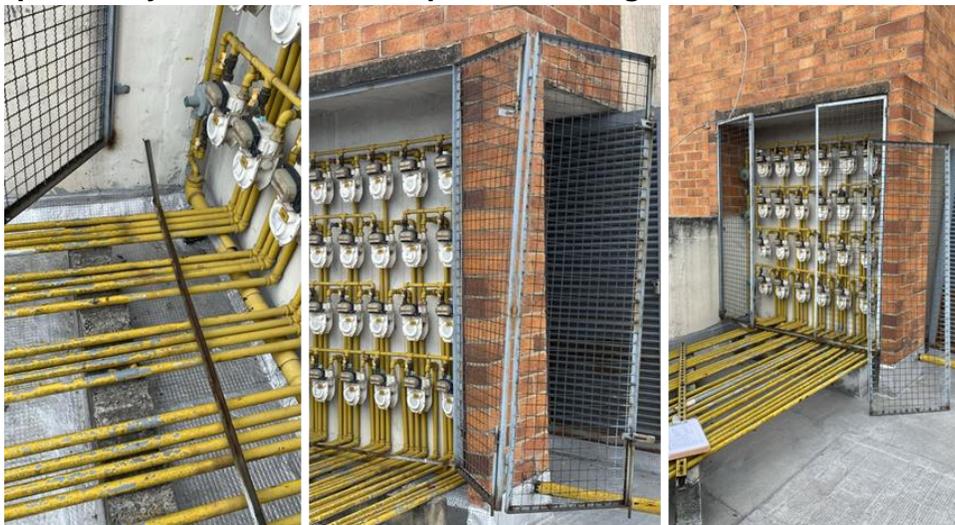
Puertas metálicas de la zona lateral de la rampa de acceso al sótano.
